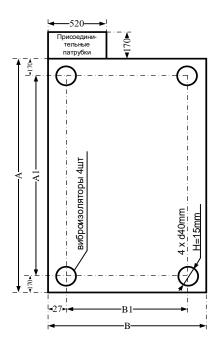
Схема габаритных размеров и крепления виброизоляторов к ККБ моделей 020÷035 (вид снизу)
